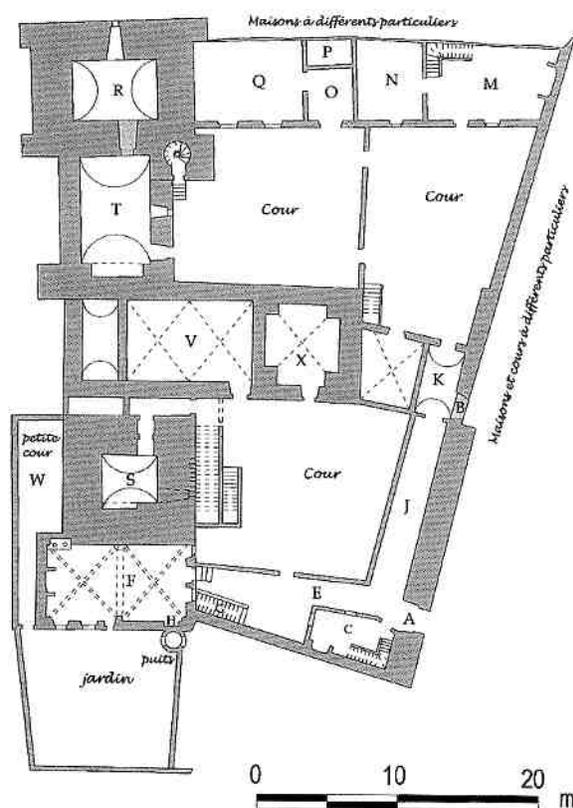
Plan des deux châteaux secondaires en 1811, par David. (Copie du plan original).
